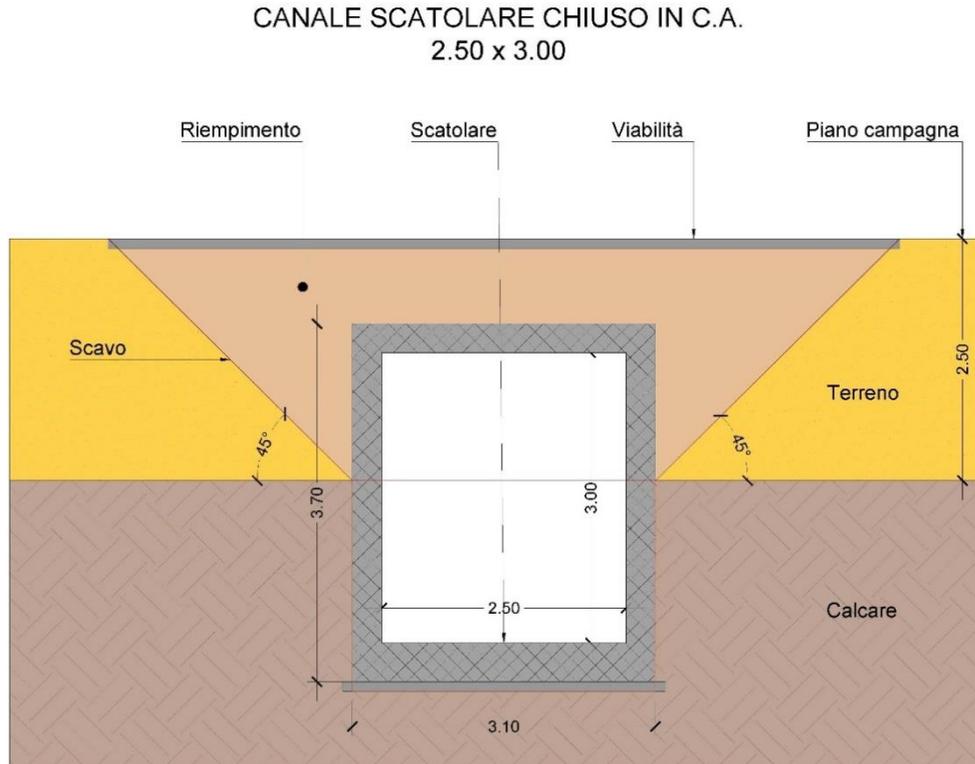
Sezione tipo 1 del canale passante per un’area di rispetto dei boschi
